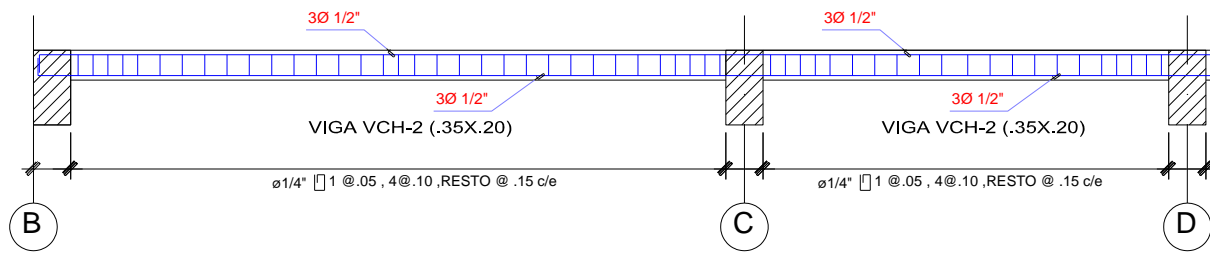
Detalle del Acero en la viga Chata 35x20 (primera parte)
